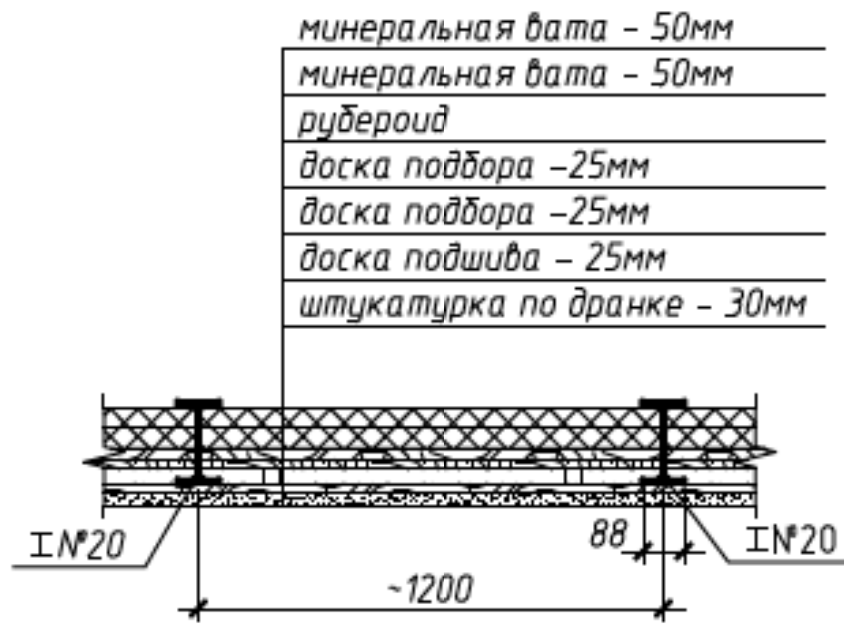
Вскрытие 1(чердачное перекрытие)
